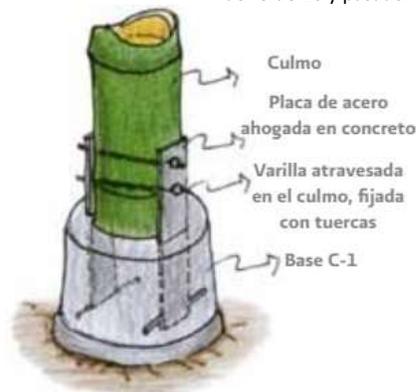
Anclaje de columnas, pies derechos y verticales a la cimentación con solera de acero y pernos.
